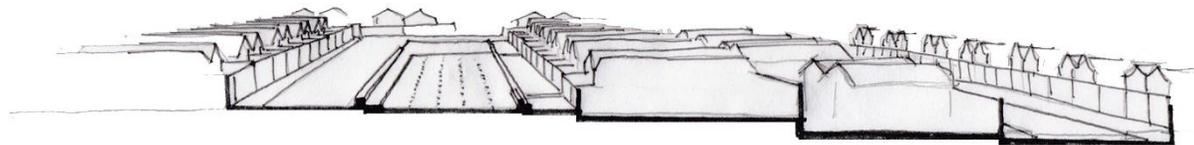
Plano de sub plazas propuestas en pasaje 601
